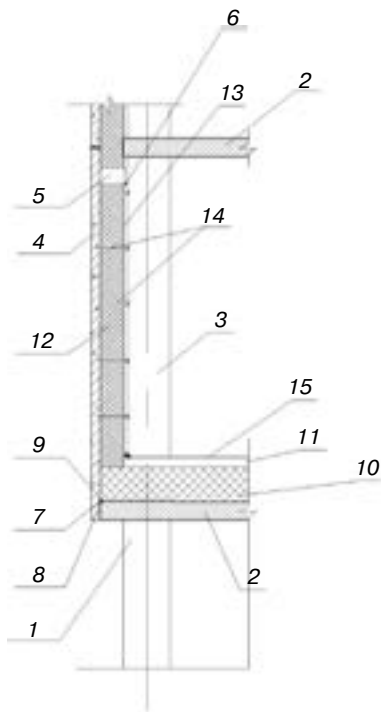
Конструкция решения углового стыка стены и цокольного перекрытия без теплопроводных включений, основанная на применении фасадных железобетонных панелей: 1 – свайный фундамент; 2 – монолитное железобетонное перекрытие; 3 – колонна; 4 – железобетонная панель; 5 – железобетонная шпонка; 6 – крюк; 7, 8, 9 – закладные детали; 10 – утеплитель из пенополистирола; 11 – цементно-песчаная стяжка; 12 – утеплитель стены из пенополистирола; 13 – внутренняя облицовка из гипсокартонных листов; 14 – коннекторы; 15 – линолеум; 16 – закладные детали для соединения с верхней панелью
